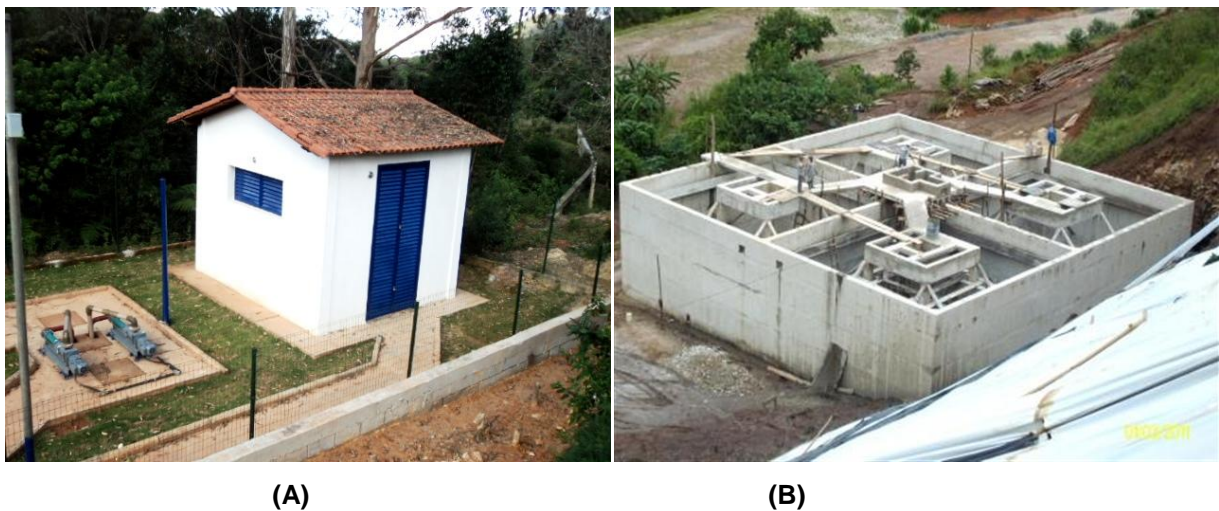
(A) ESTAÇÃO ELEVATÓRIA SÃO SEBASTIÃO; (B) ETE SEDE EM CONSTRUÇÃO. FONTE: SEMAE-OURO PRETO, 2013.
